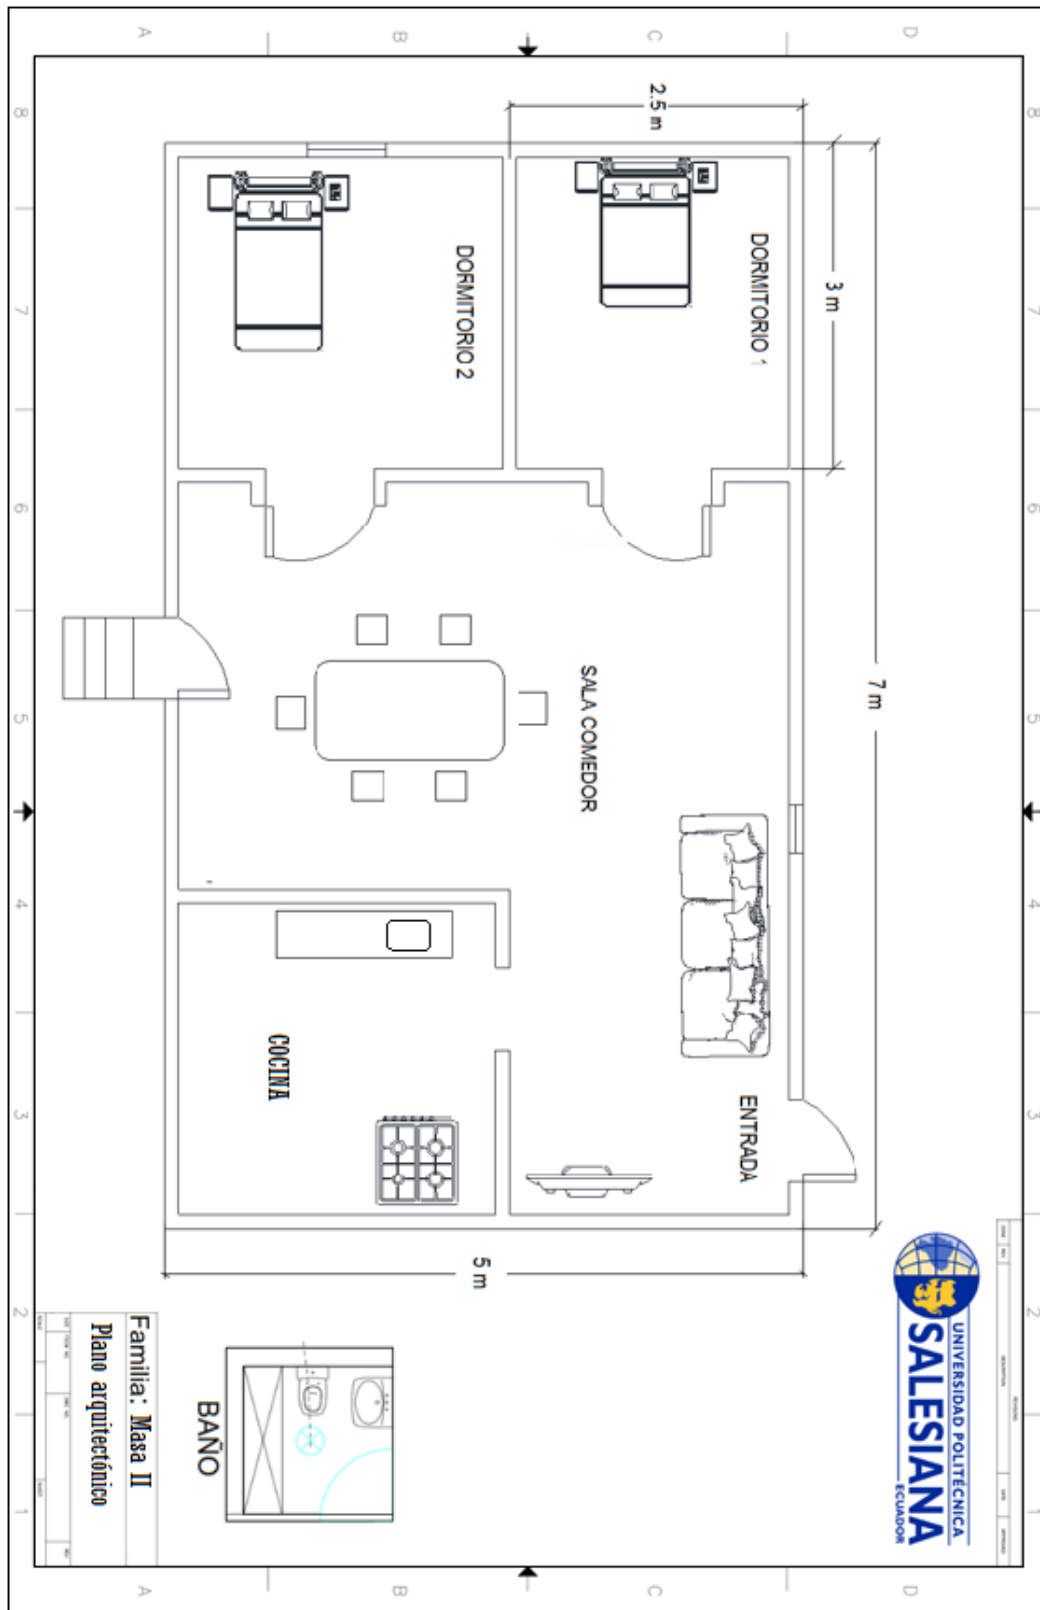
Plano arquitectónico de la vivienda. Fuente: Los autores
